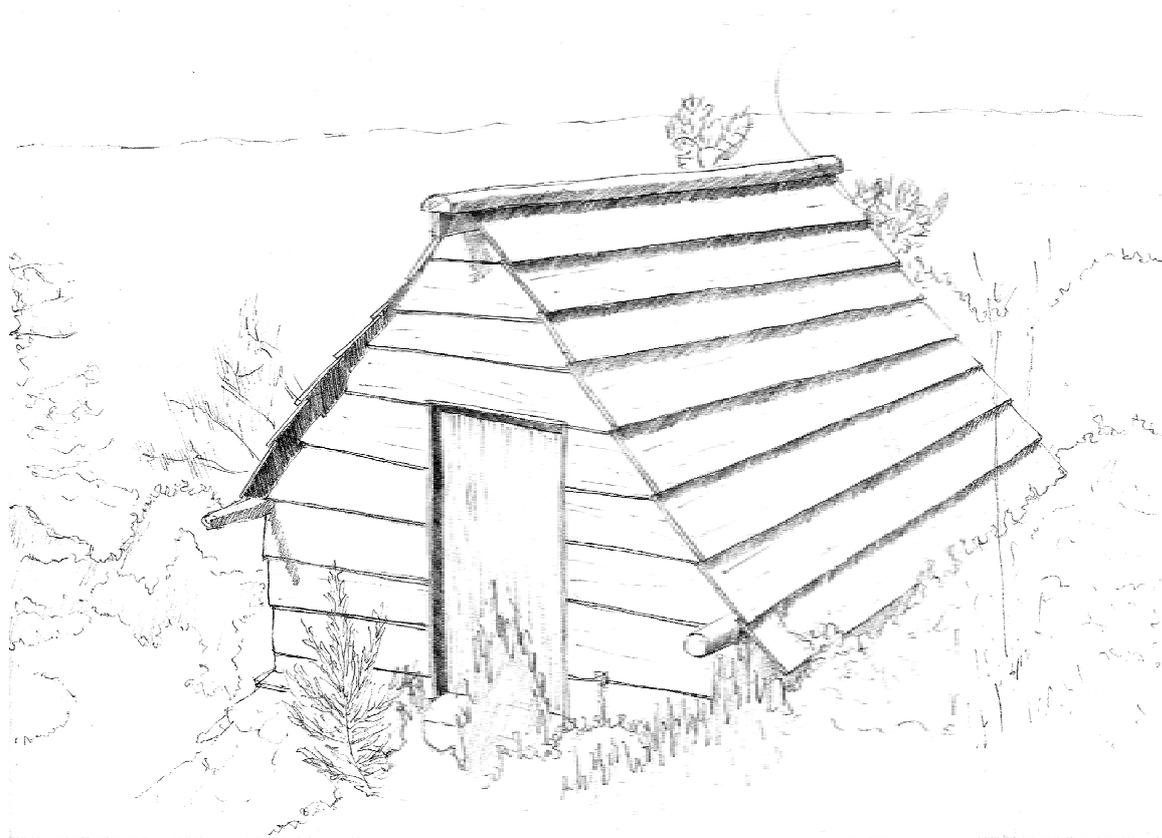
Edificación con cubierta y paredes de tea, La Palma. Elaboración propia.
